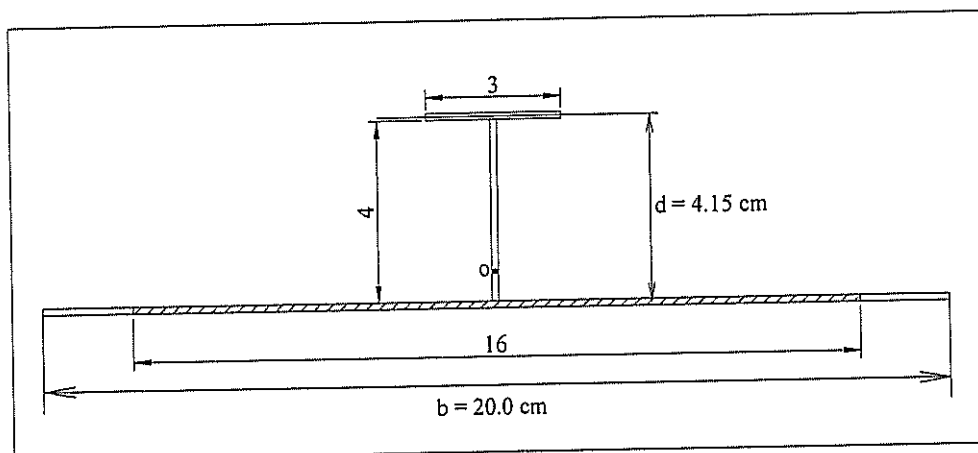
Esquema de plancha con refuerzo, Modo N° 3.
